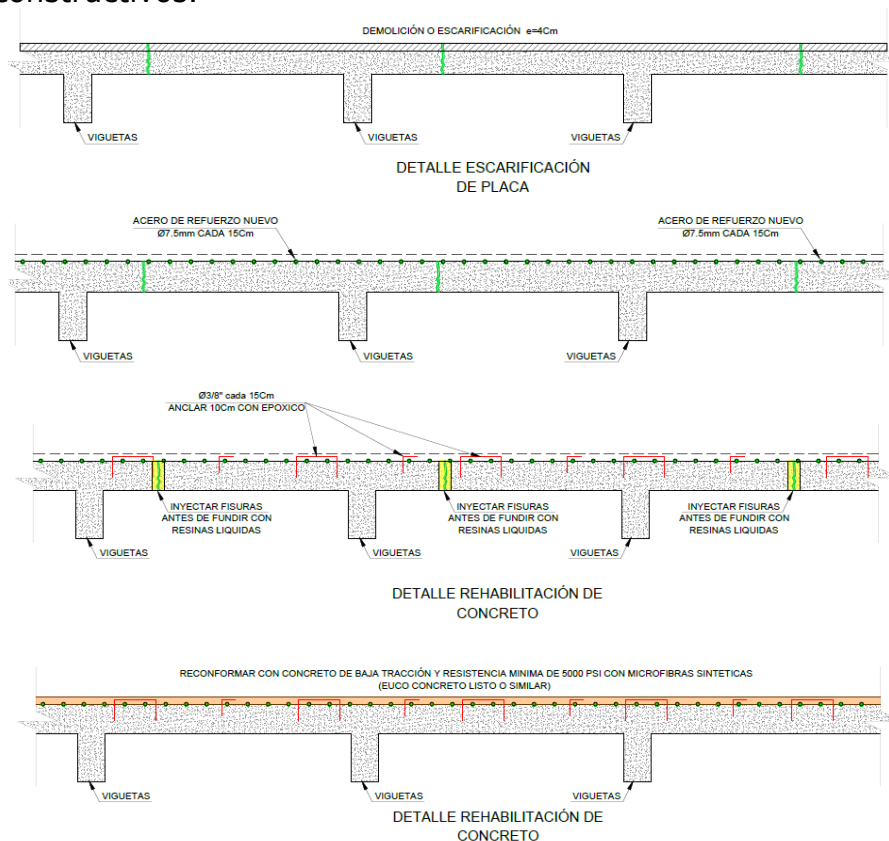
Detalles constructivos rehabilitación placas de sótanos.
